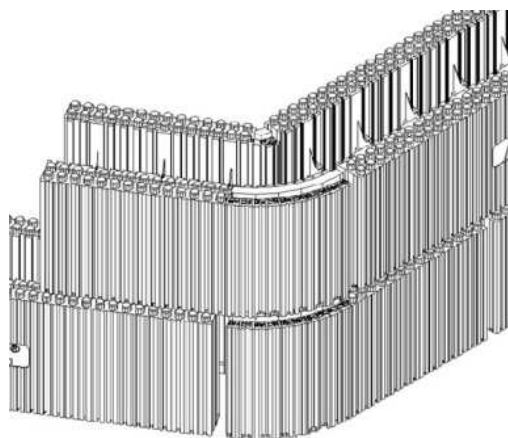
Canto de parede com elementos de canto redondos cortados (ARGISOL, 2010).
